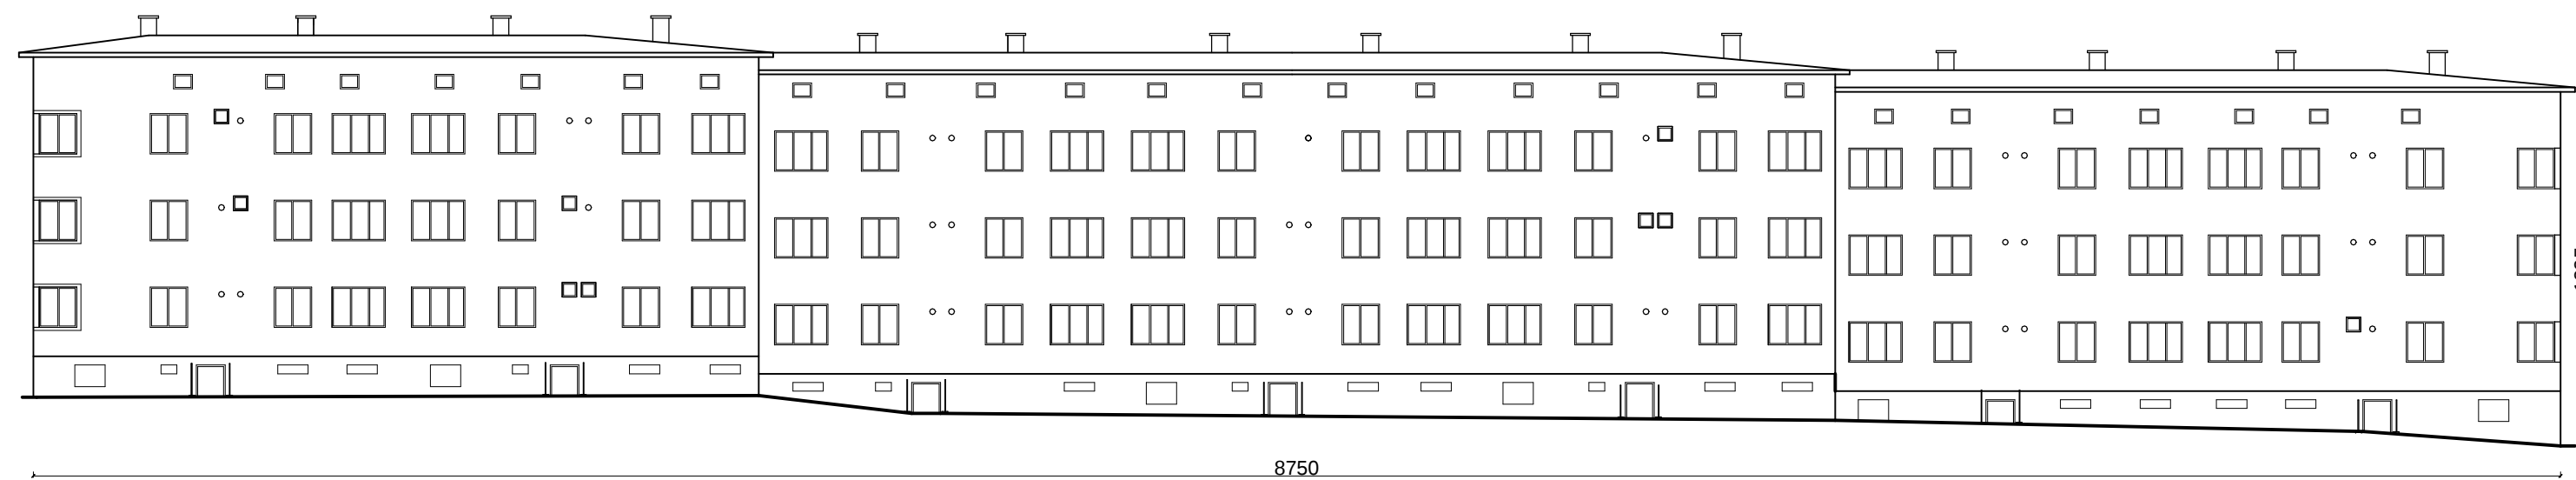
Elewacja od podwórza – południowo-wschodnia
